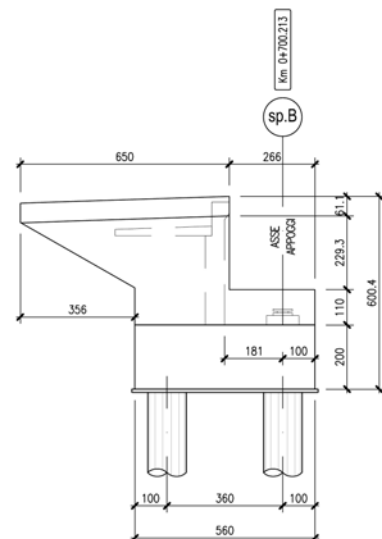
CARPENTERIA SPALLE.
